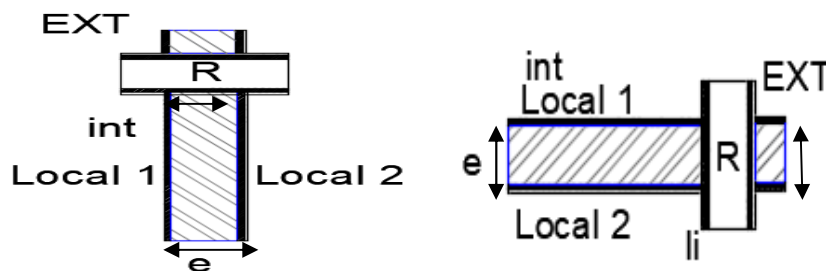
Les liaisons entre une paroi intérieure et une paroi extérieure (refond/façade, cloison/façade, plancher/façade).
